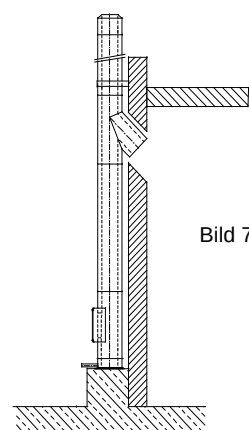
Aufbau mit Grundplatte für Sockelmontage
